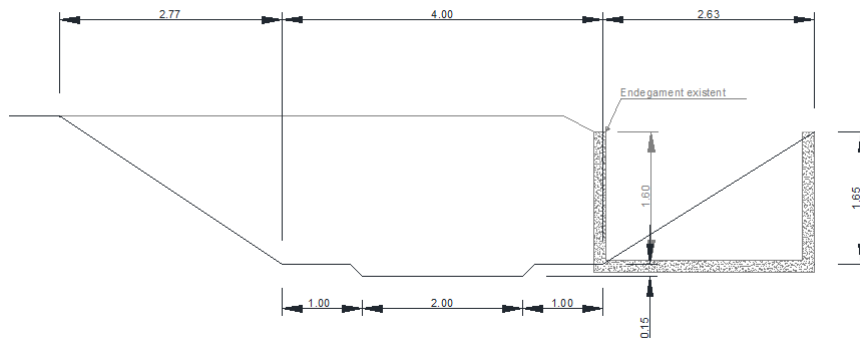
Secció de l'endegament en terres comparada amb la secció existent.
